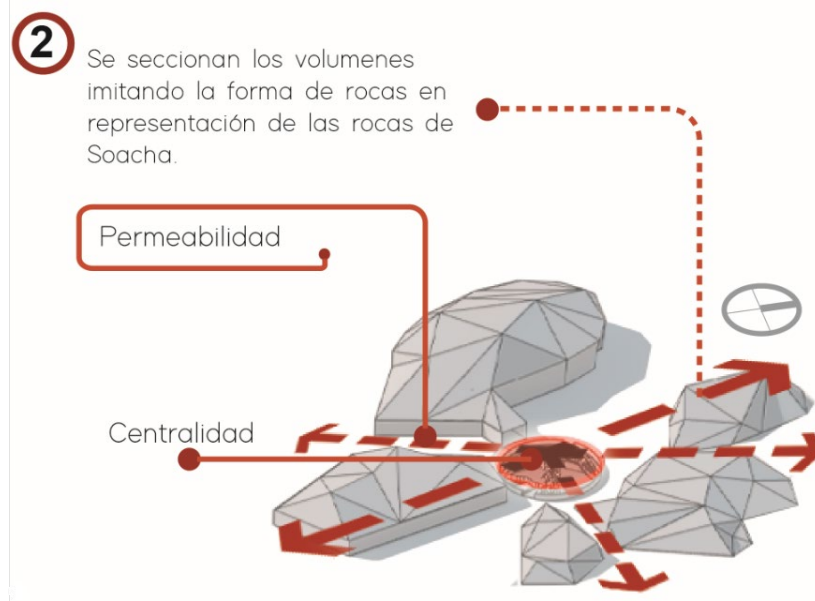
Paso 2, permeabilidad y planteamiento de las circulaciones externas del proyecto. Elaboración propia.
